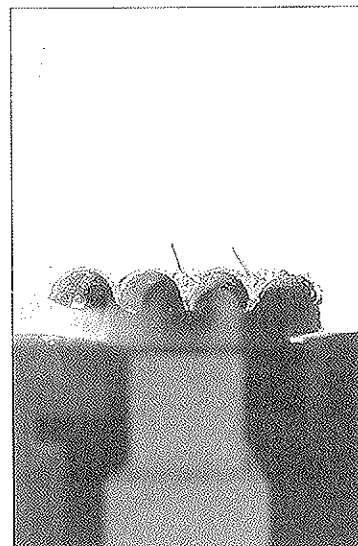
Detalle de los tubos de desviación del pretensado (Máximo; cuatro cordones 0,6" por lado de la viga).
